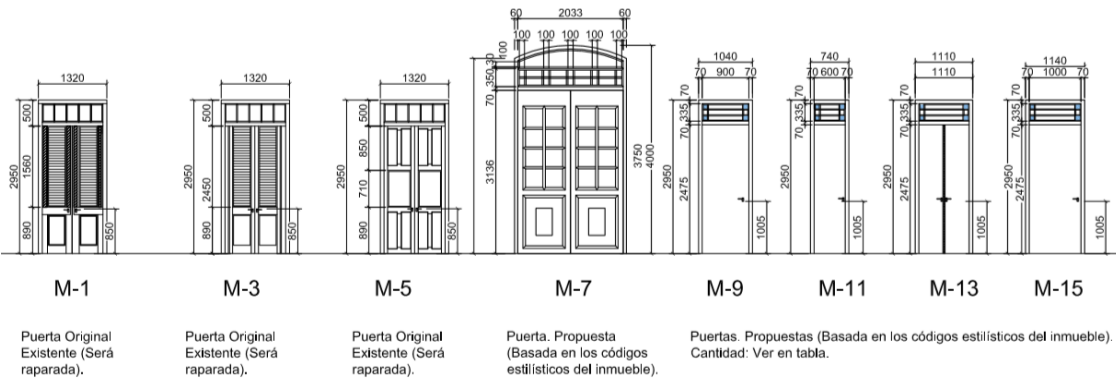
Elevaciones de carpintería. Nivel 1. Propuesta
